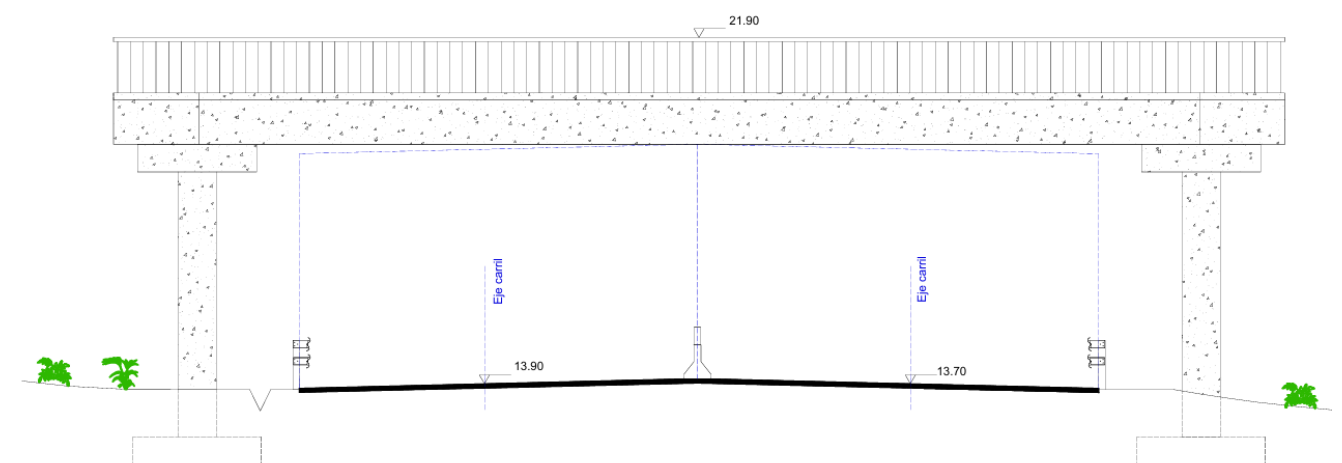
Solución tipo viga de hormigón pretensado; Fuente: Elaboración propia
